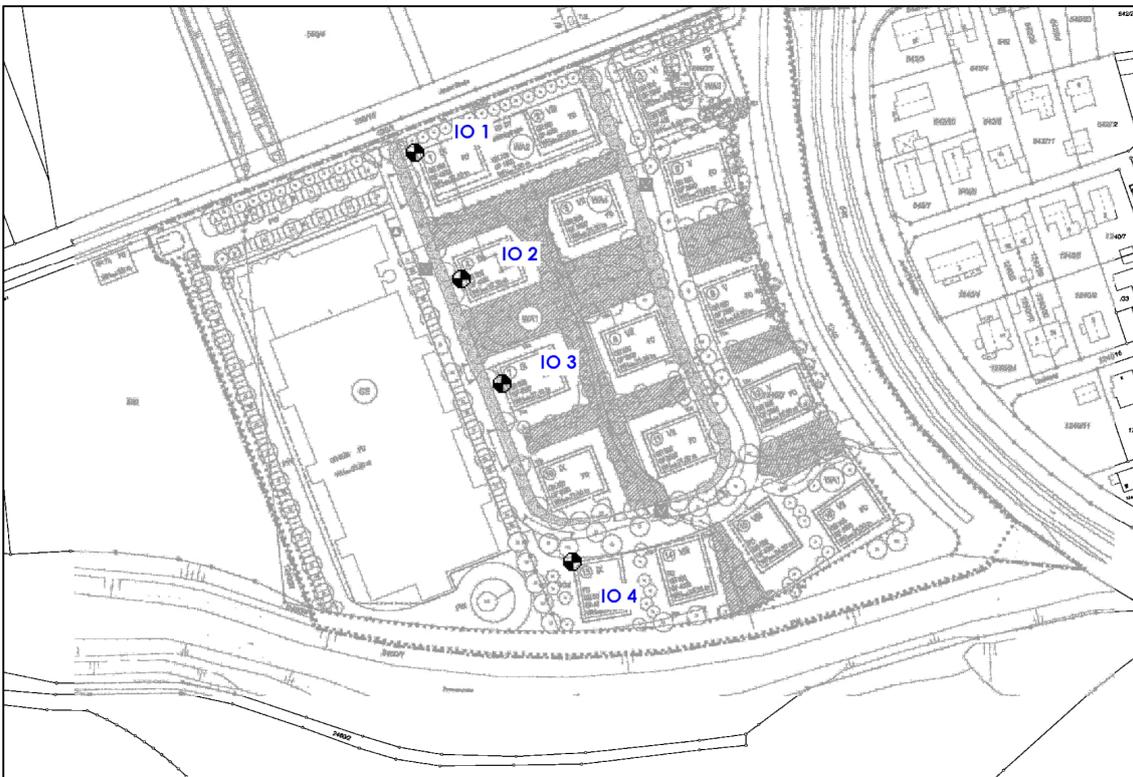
Lageplan mit Darstellung der maßgeblichen Immissionsorte
